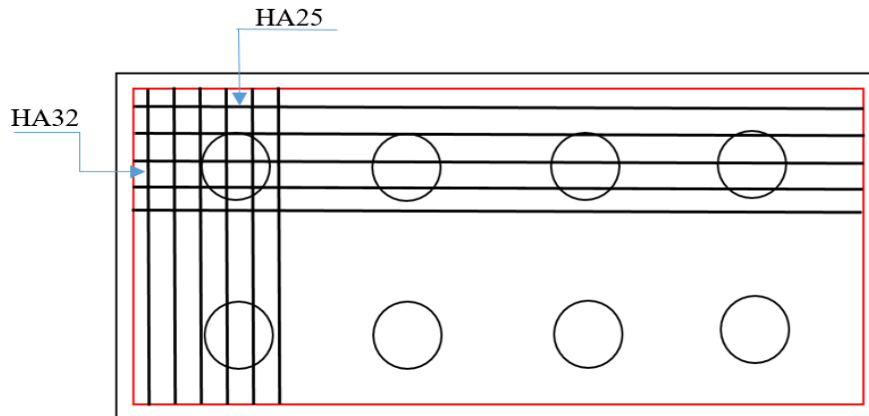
FERRAILLAGE DE LA NAPPE INFERIEUR DE LA SEMELLE
